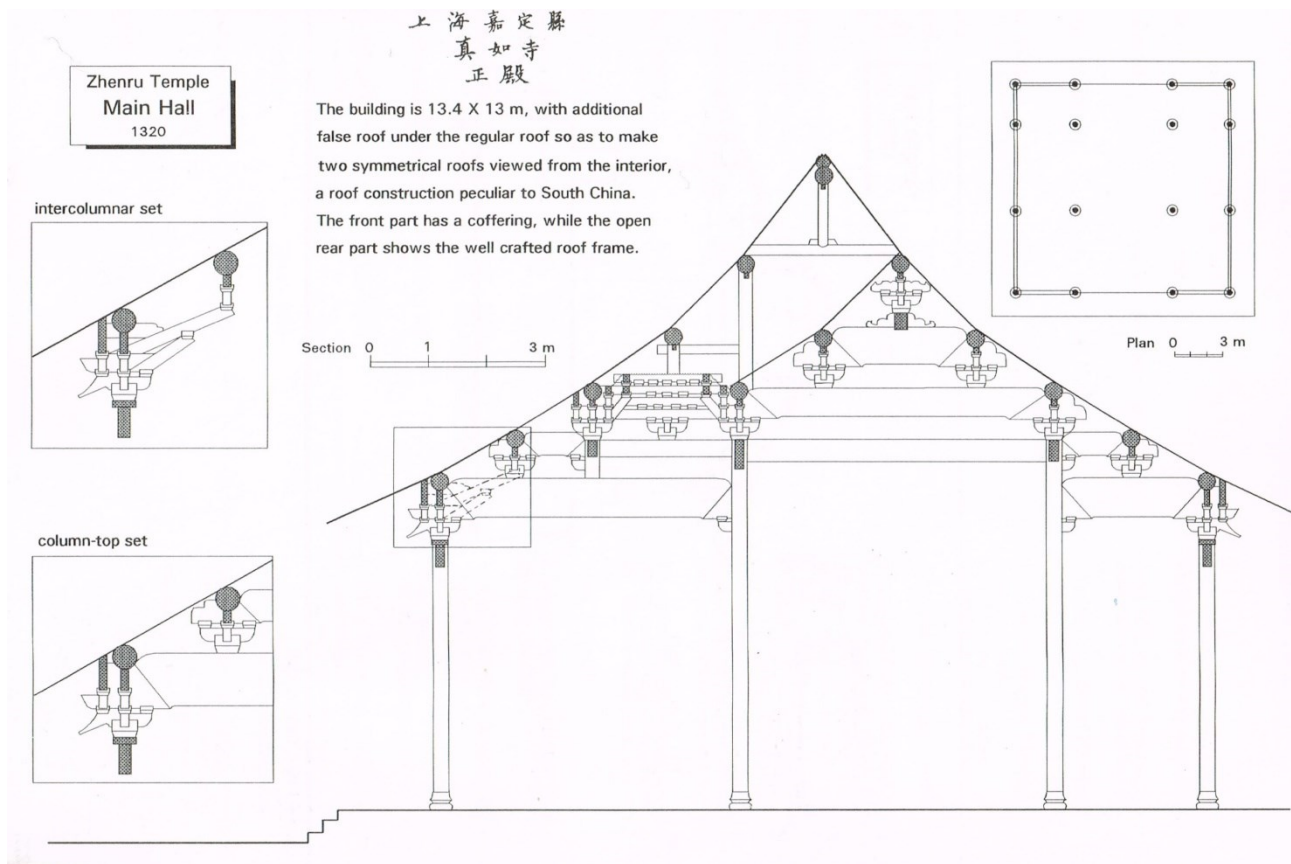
Die Haupthalle des Zhēnrú-Tempels in Shanghai. Querschnitt und Grundriss (Guo 1995, 221).
